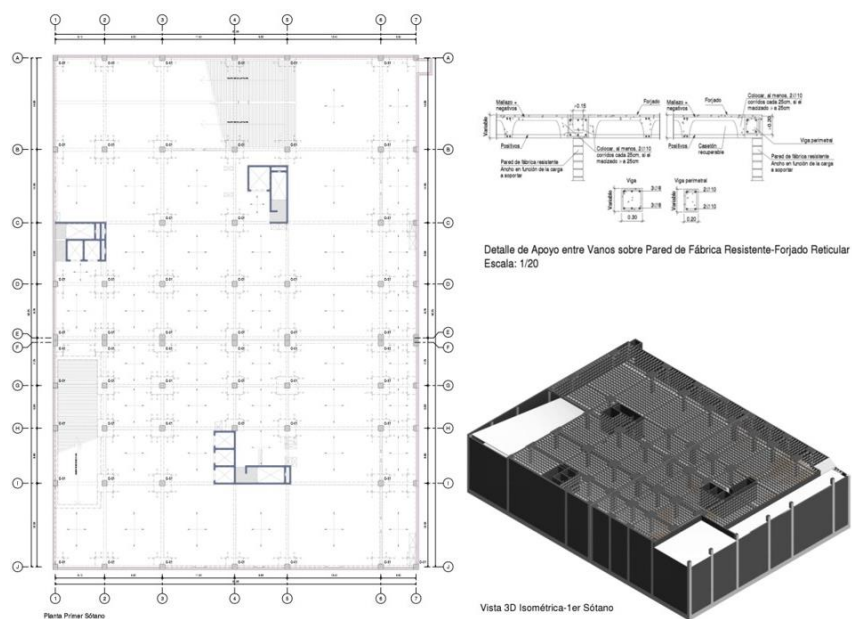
Vista planta e isométrica del primer nivel sótano + detalle del corte del forjado reticular empleado en sótanos.
